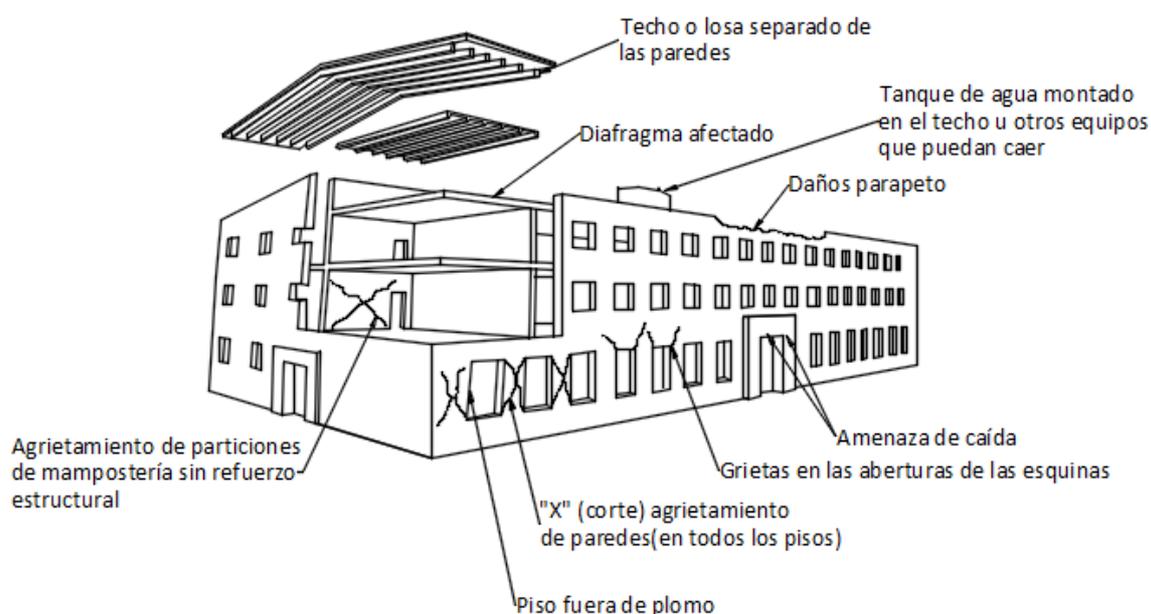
Puntos de inspección para edificaciones con sistemas estructurales de muros de hormigón armado.
